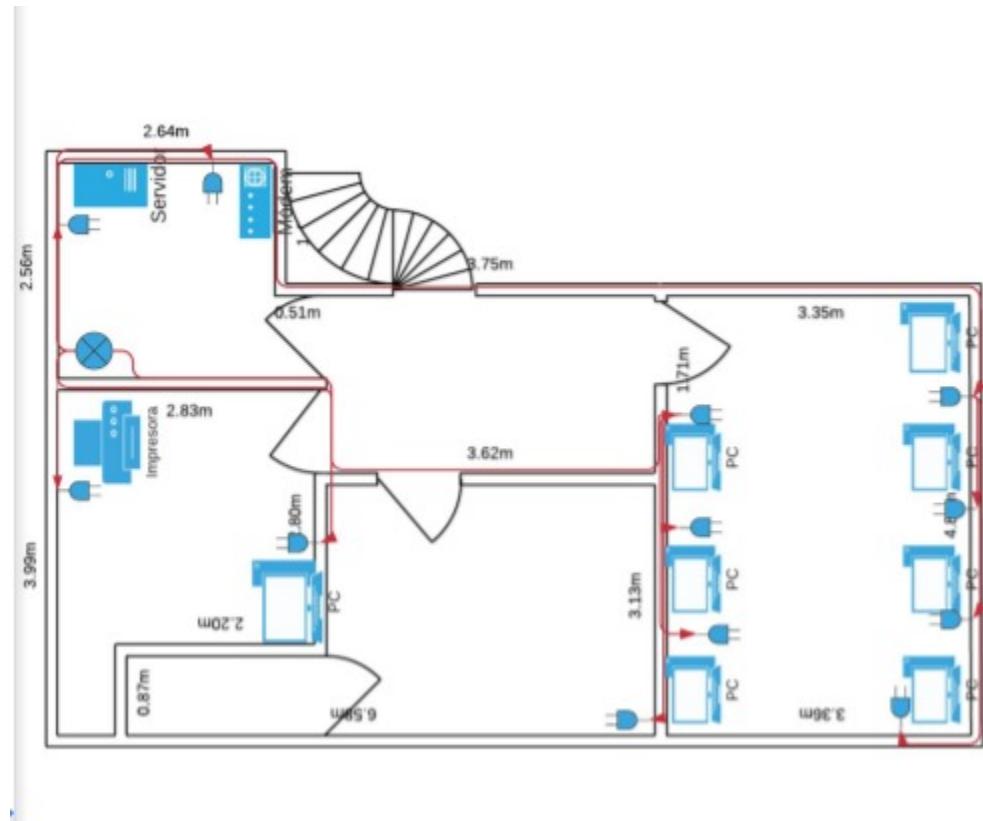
Plano eléctrico Álvaro Zarate (2021)
